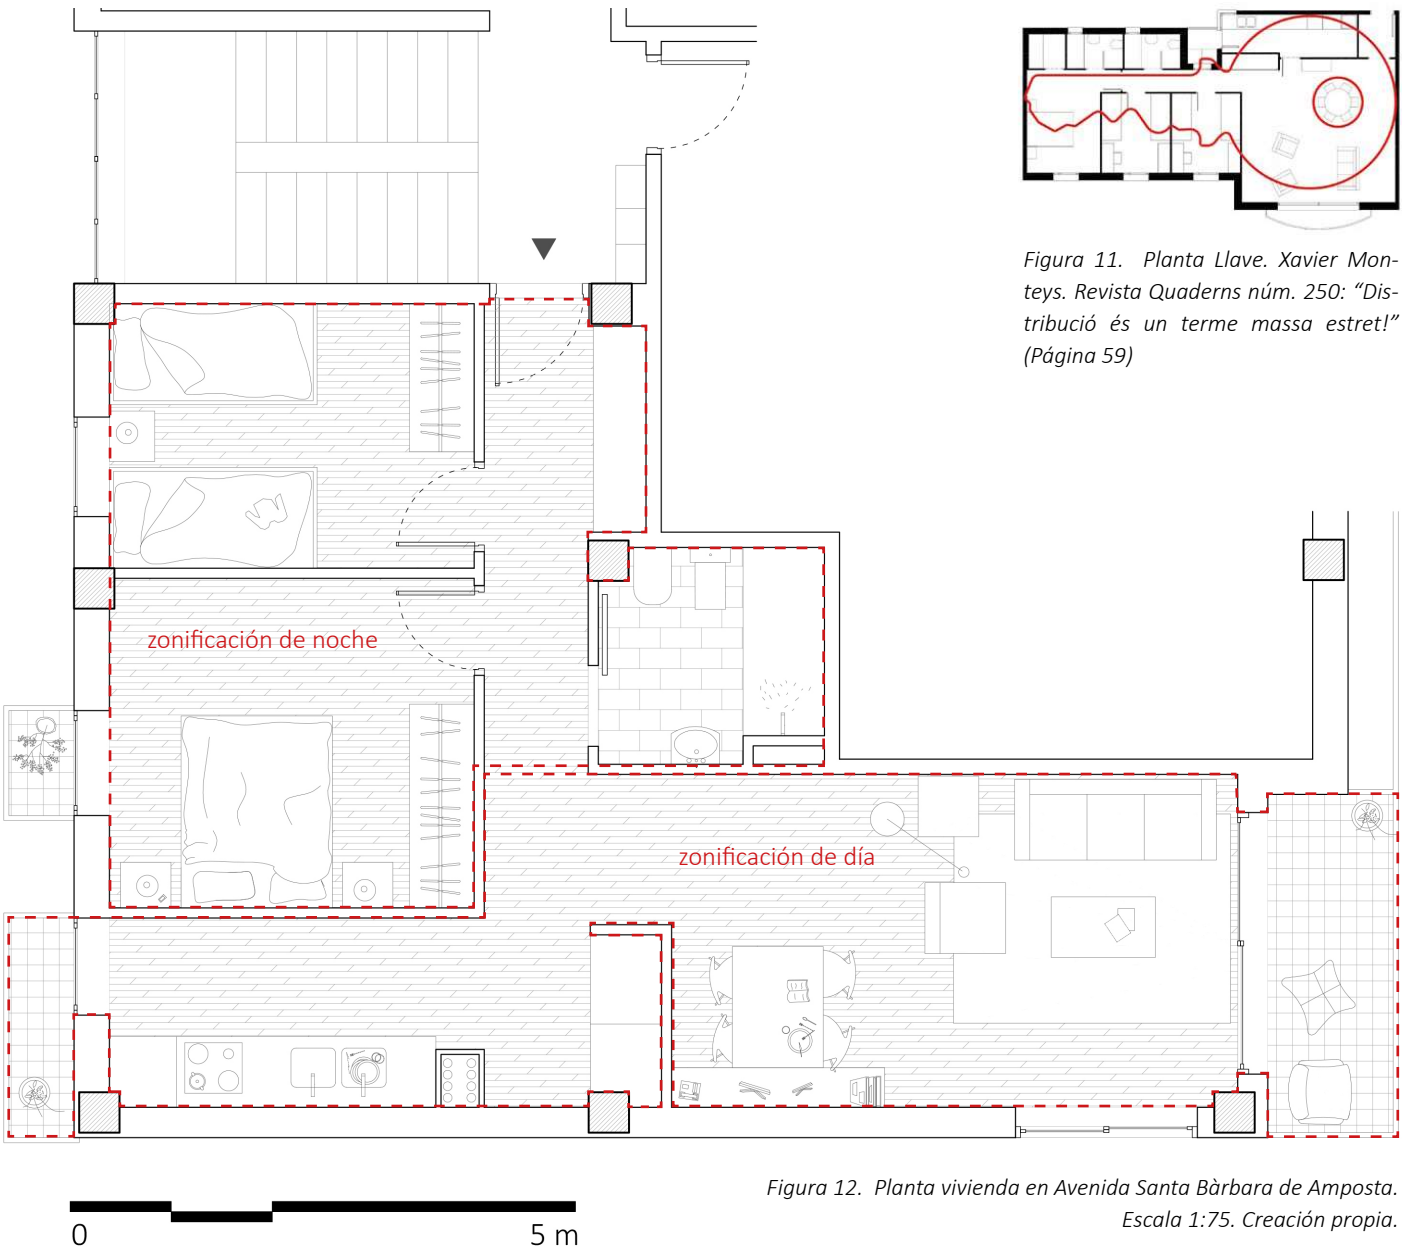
Planta vivienda en Avenida Santa Bàrbara de Amposta. Escala 1:75. Creación propia.
